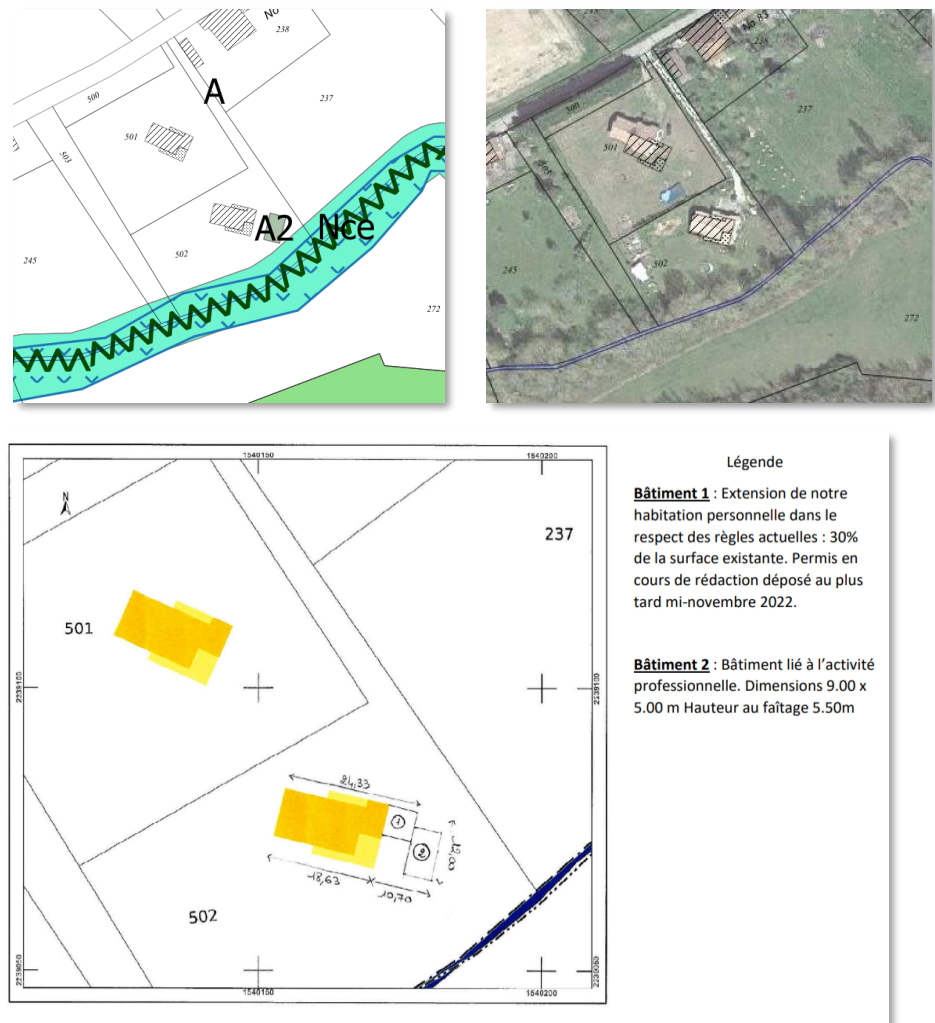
Localisation du STECAL A2 et plan de détail du projet
